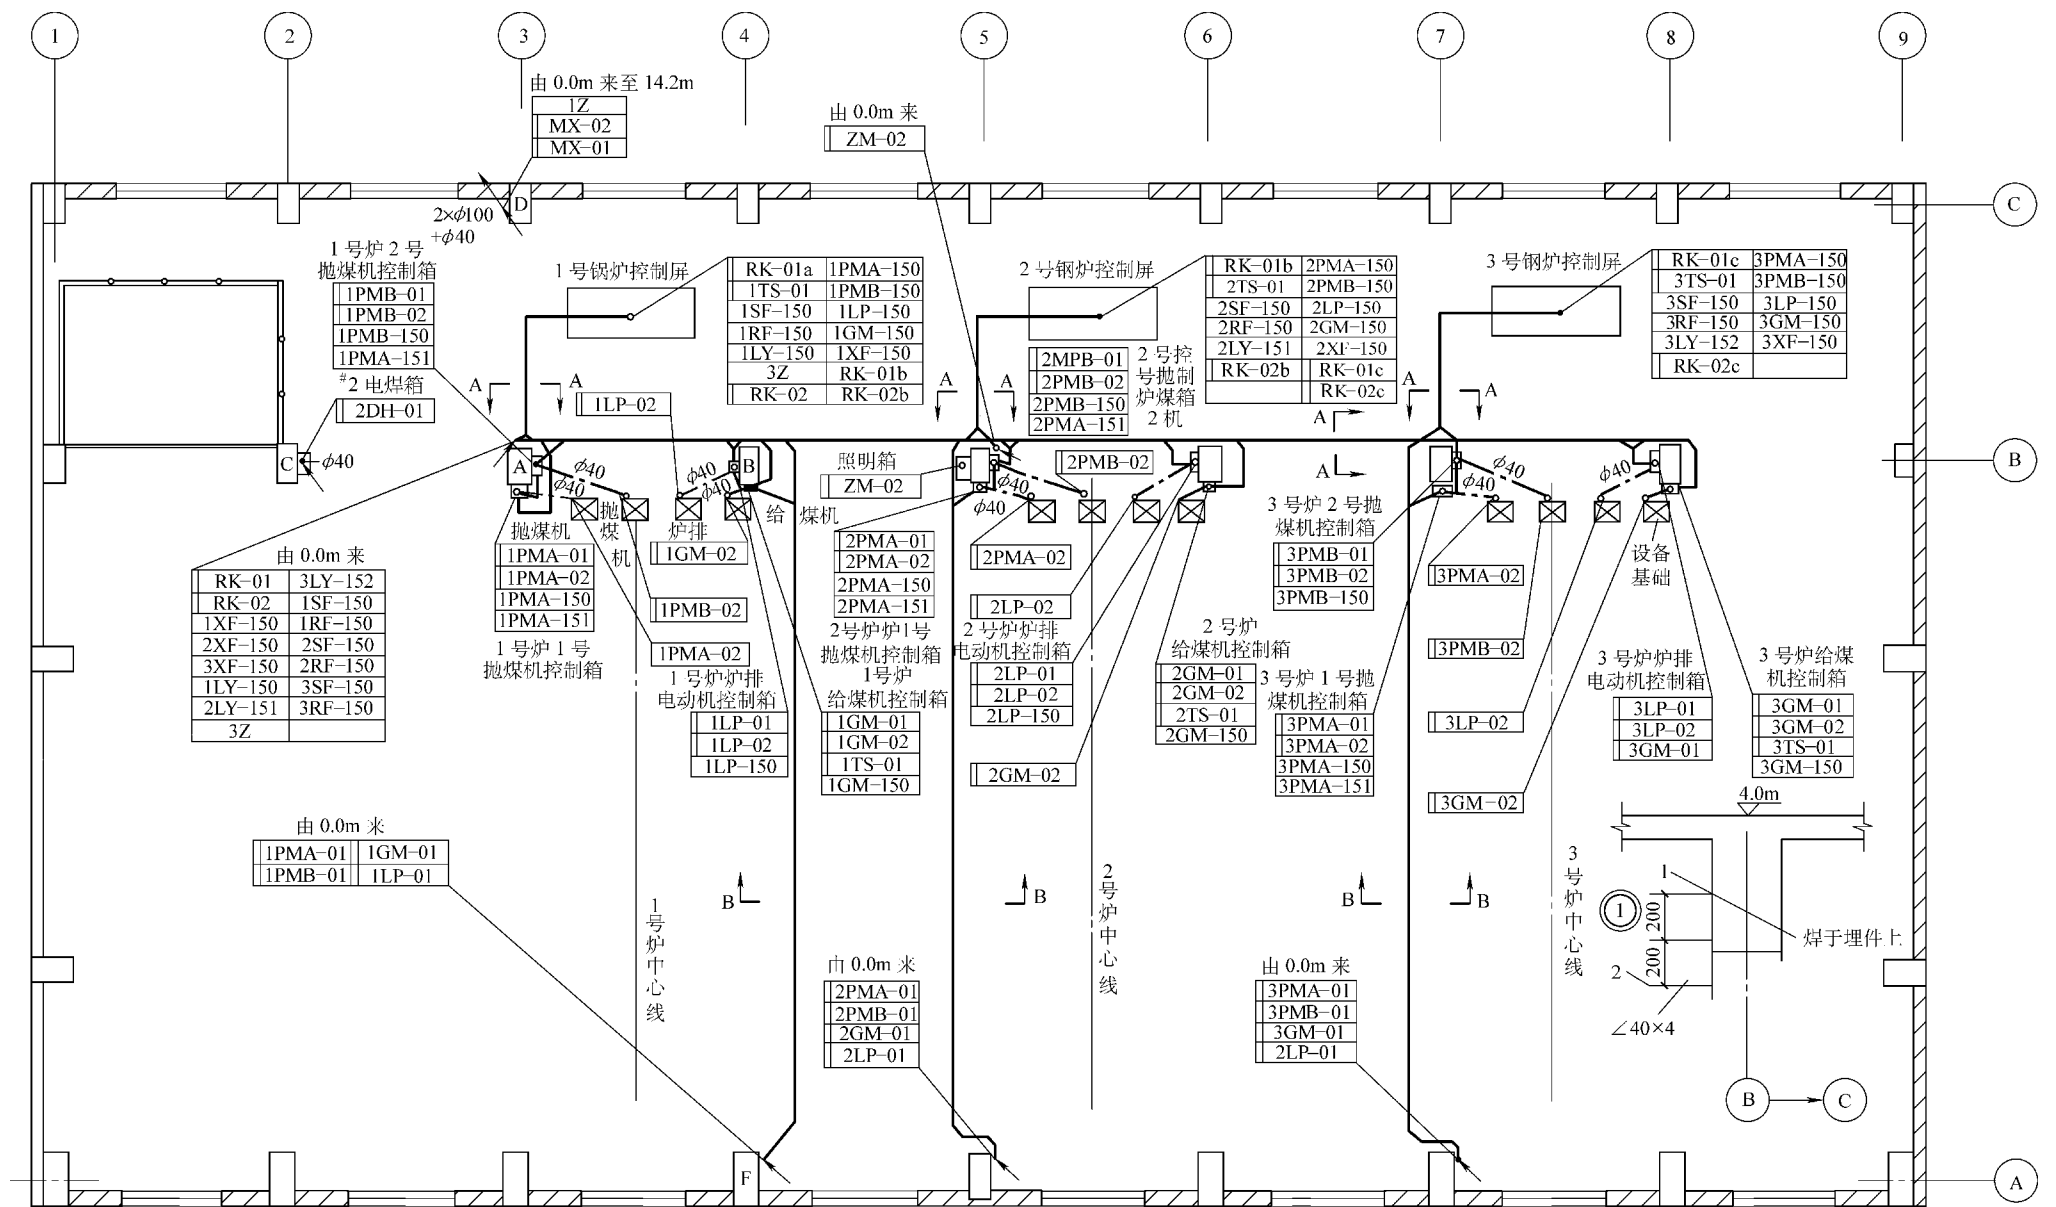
锅炉房 4m 标高 (运转层) 电缆敷设平面图
